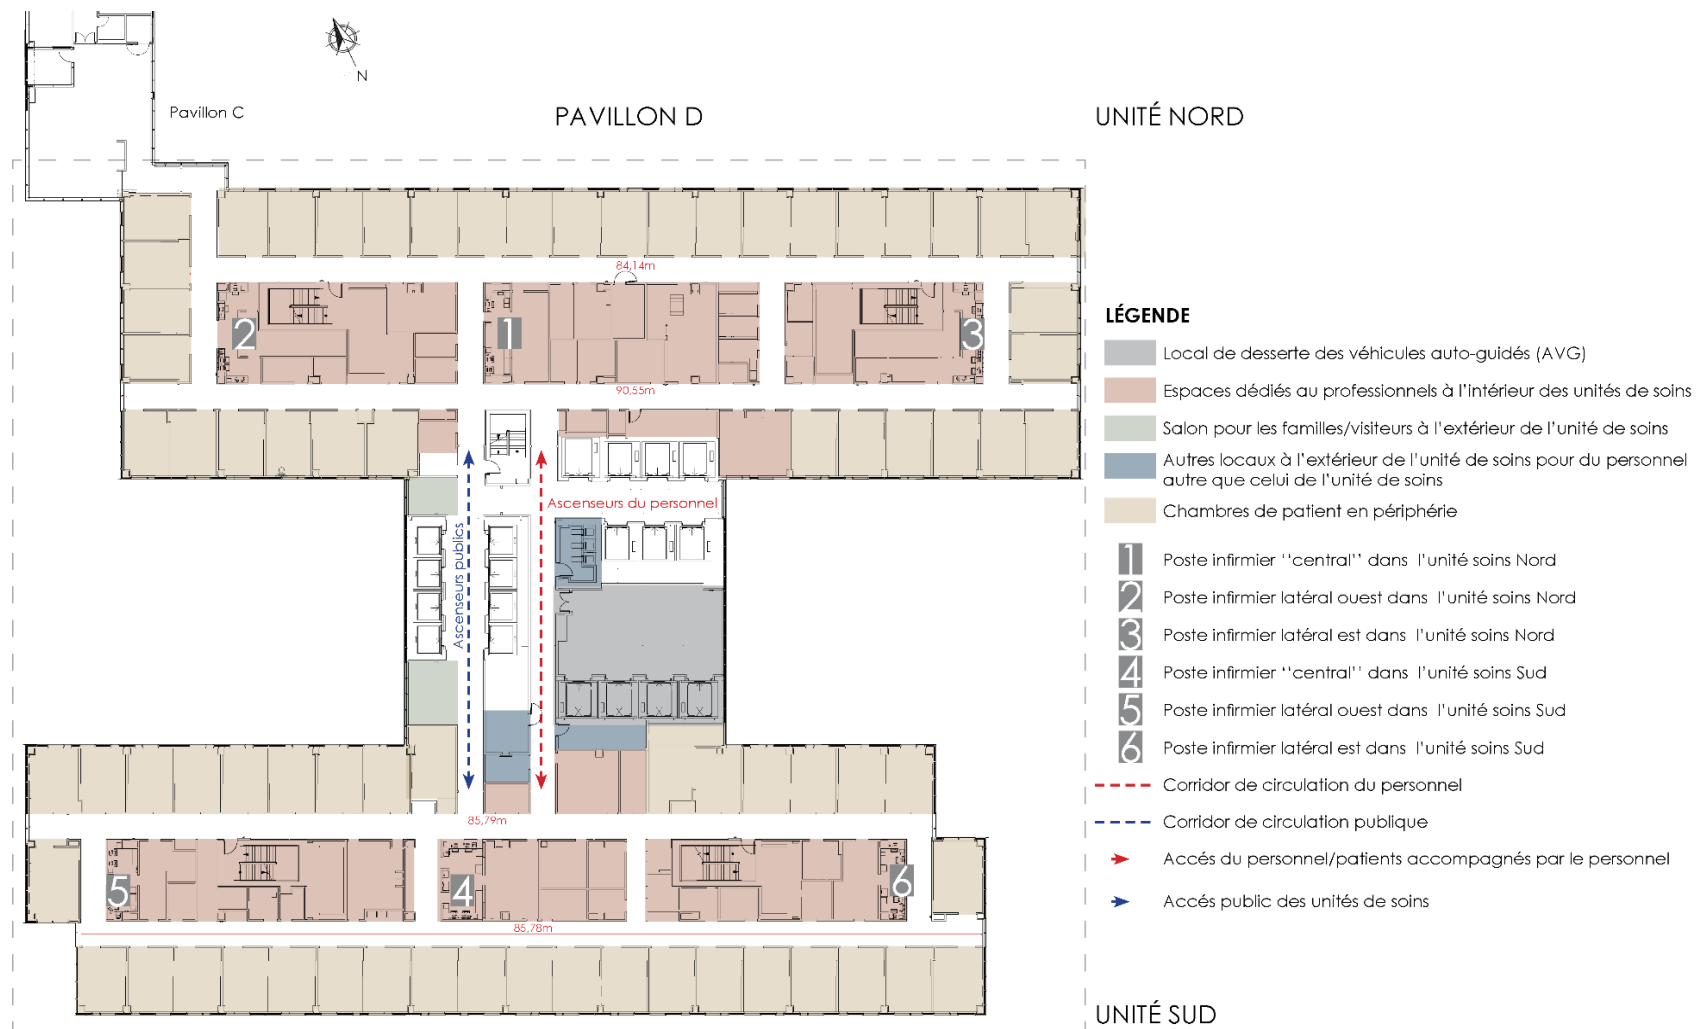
Plan type d'un étage du pavillon D, nouveau CHUM.
